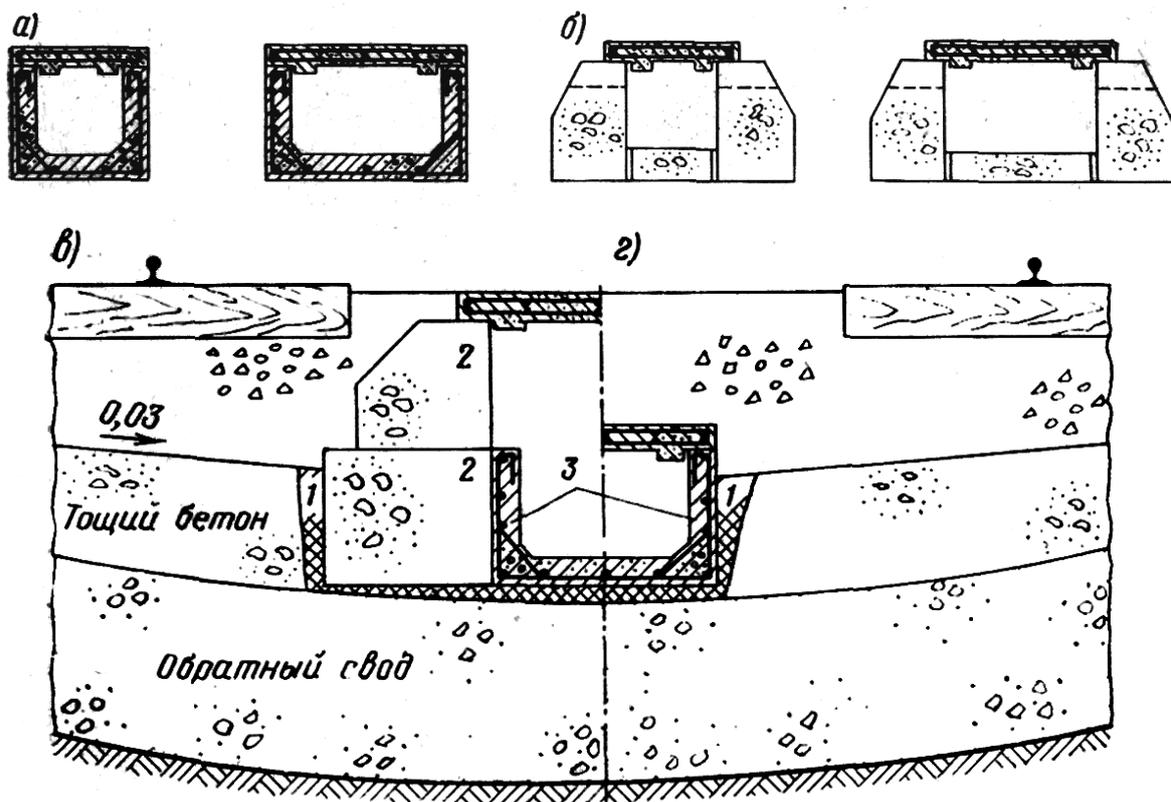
Сборные лотки: а – железобетонные; б – бетонные; в – устройство лотка в тоннеле с обратным сводом, разрез по смотровому колодцу; г – то же, разрез по лотку; 1 – заделка блоков бетоном; 2 – блоки сборного бетона; 3 – железобетонный лоток
